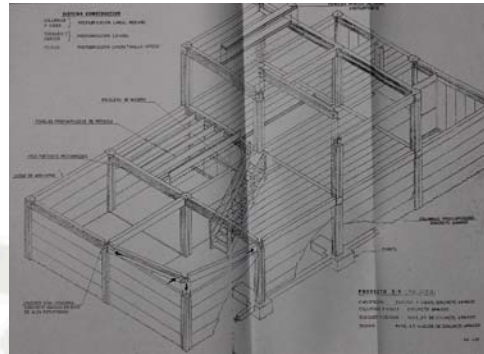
Sistema Constructivo I-5 de PREVI, base parcial de la propuesta constructiva, fuente, ministerio de vivienda.
